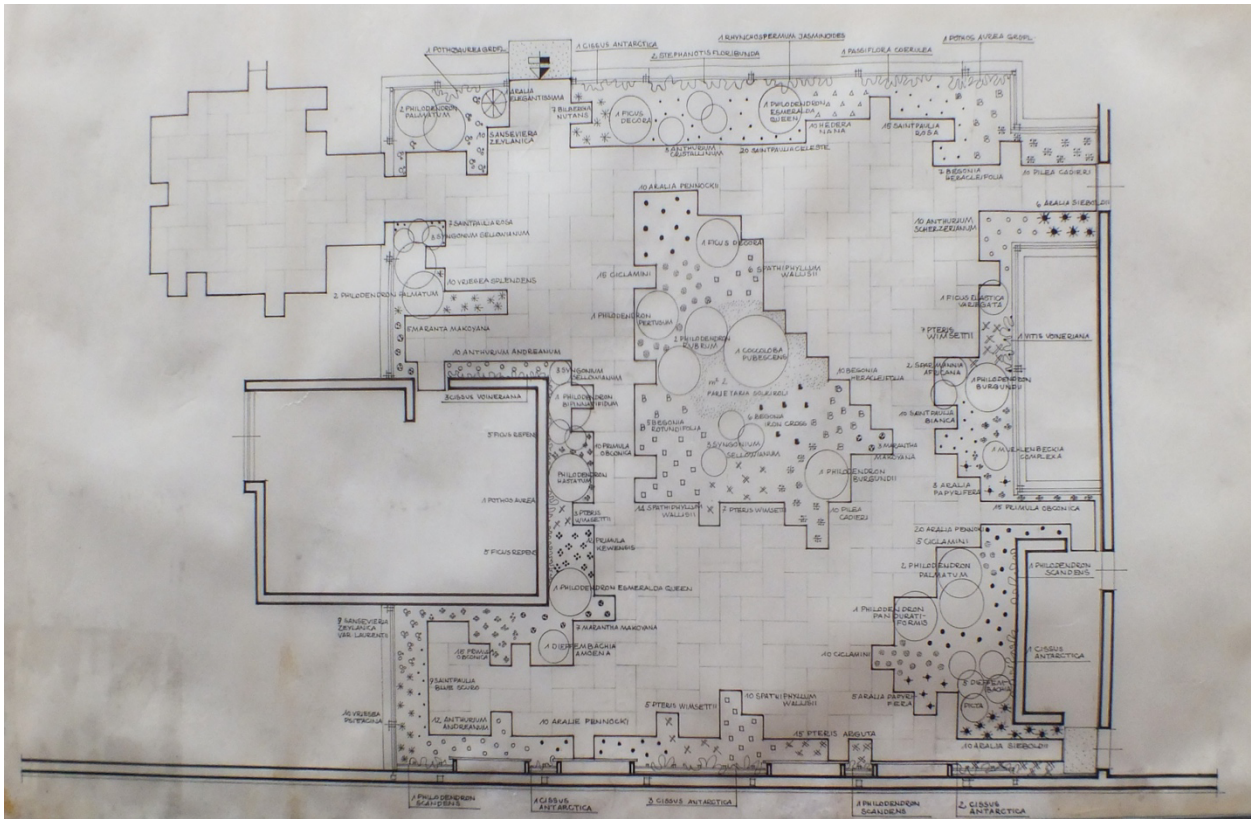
Studio Porcinai, *piantaggio serra*, ottobre 1963, disegno 1226/74 ©Archivio Pietro Porcinai, Fiesole. Per gentile concessione. La planimetria evidenzia la ricchezza delle collezioni botaniche – tra piante erbacee, arbusti e rampicanti – selezionati per il giardino d’inverno e la loro attenta disposizione nella configurazione dello spazio del ‘padiglione ospiti’.
